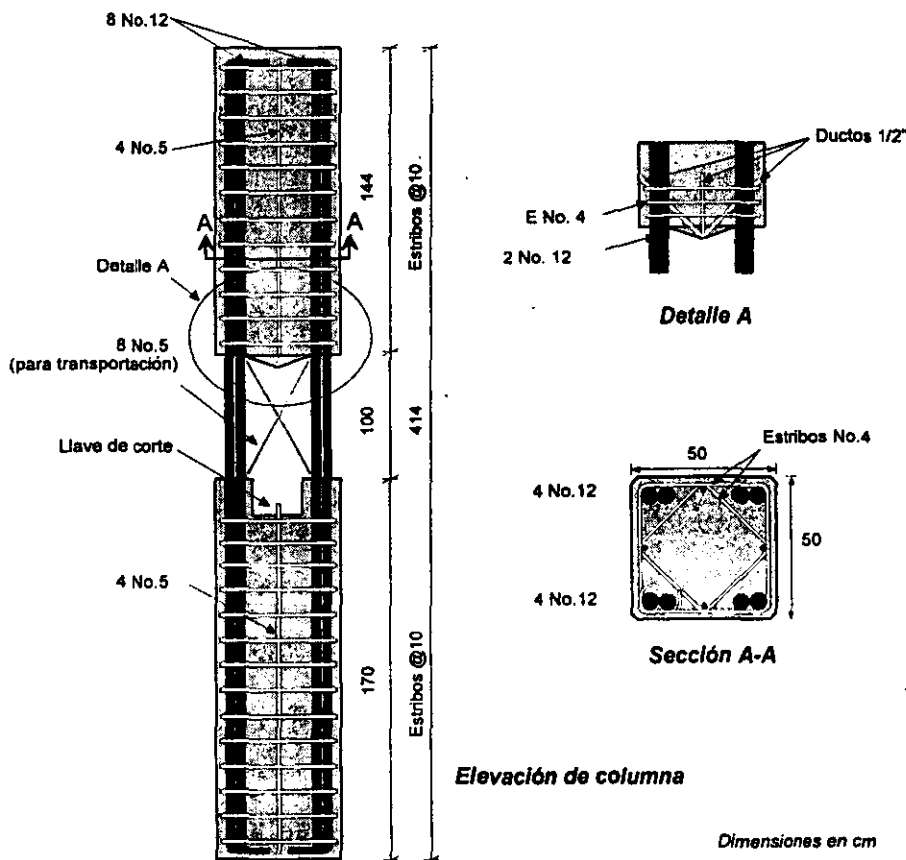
Geometría y armado de la columna del modelo J-T
